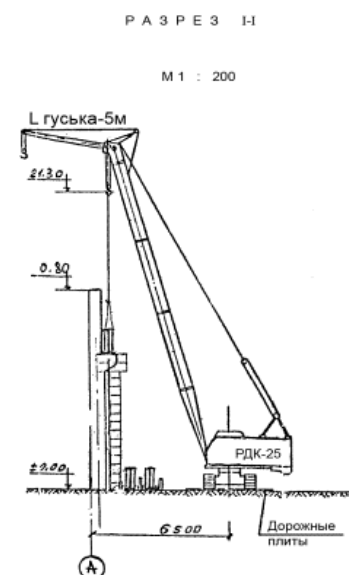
Схема монтажа подкрановых балок и подстропильных ферм
